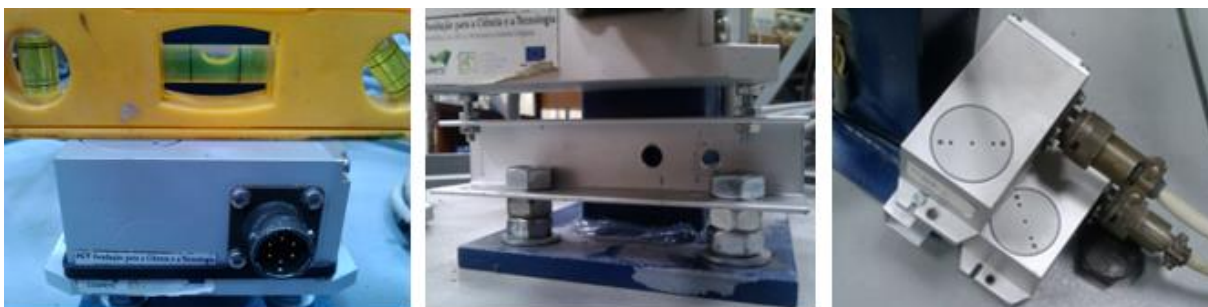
Instalação de inclinómetros da base da estrutura.
